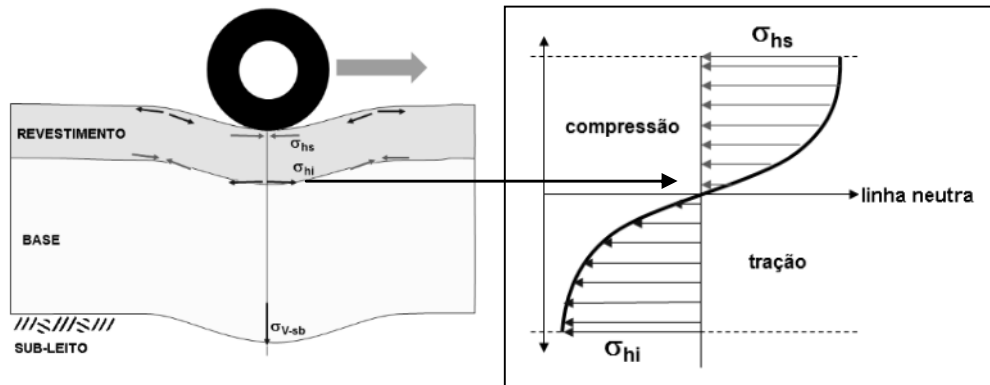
Tensões em um pavimento sob ação de carga de tráfego.
